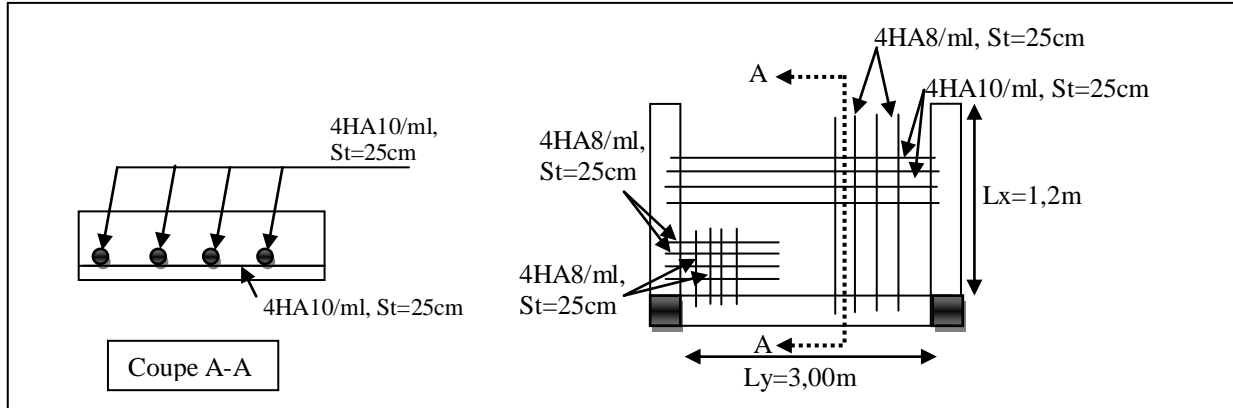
Schéma de ferrailage dalle sur 3 appuis
